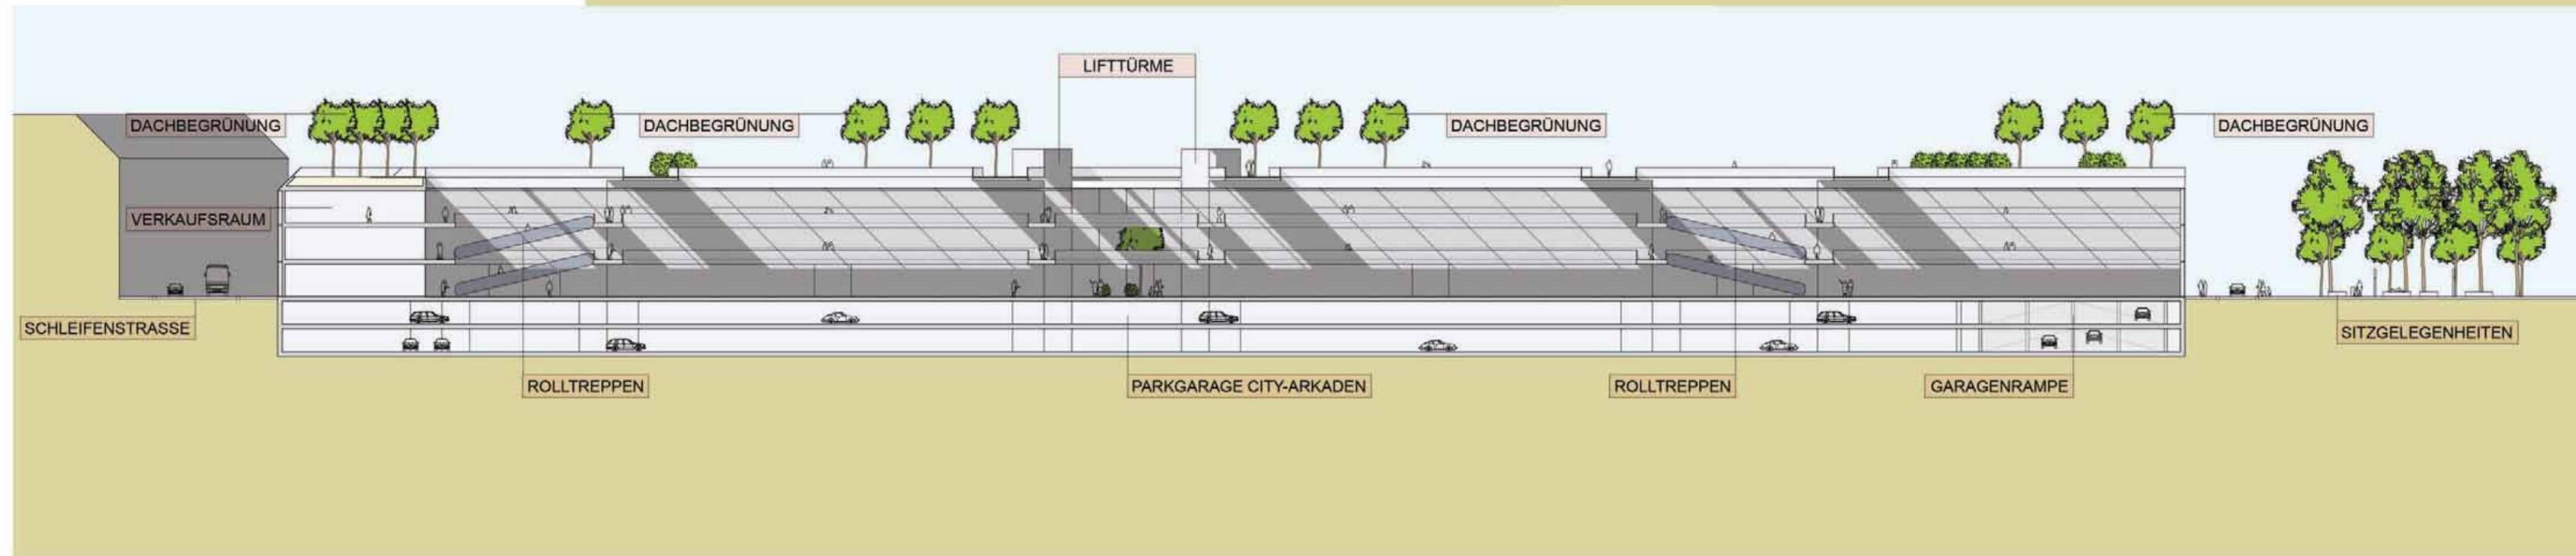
DETAIL ALTER PLATZ (vgl. Unterkapitel 4.4.1)
